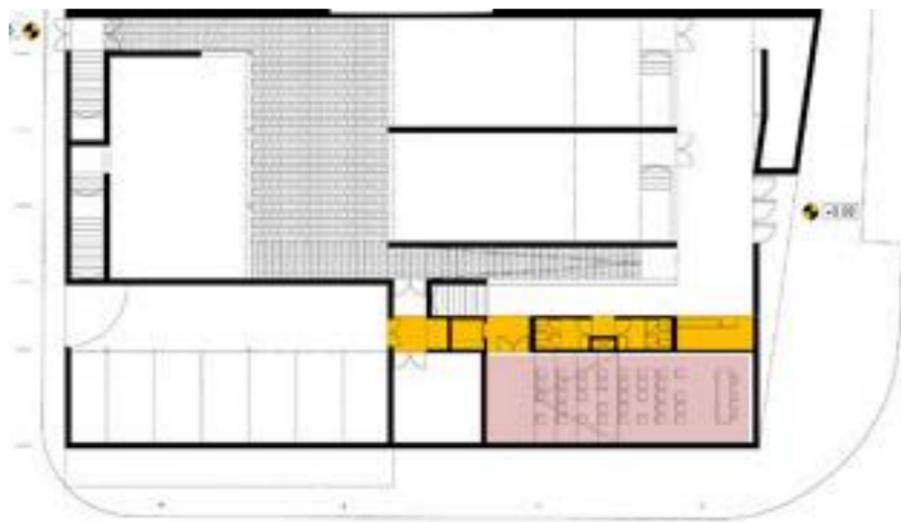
Planta baja. (2019), Plataforma Arquitectura
